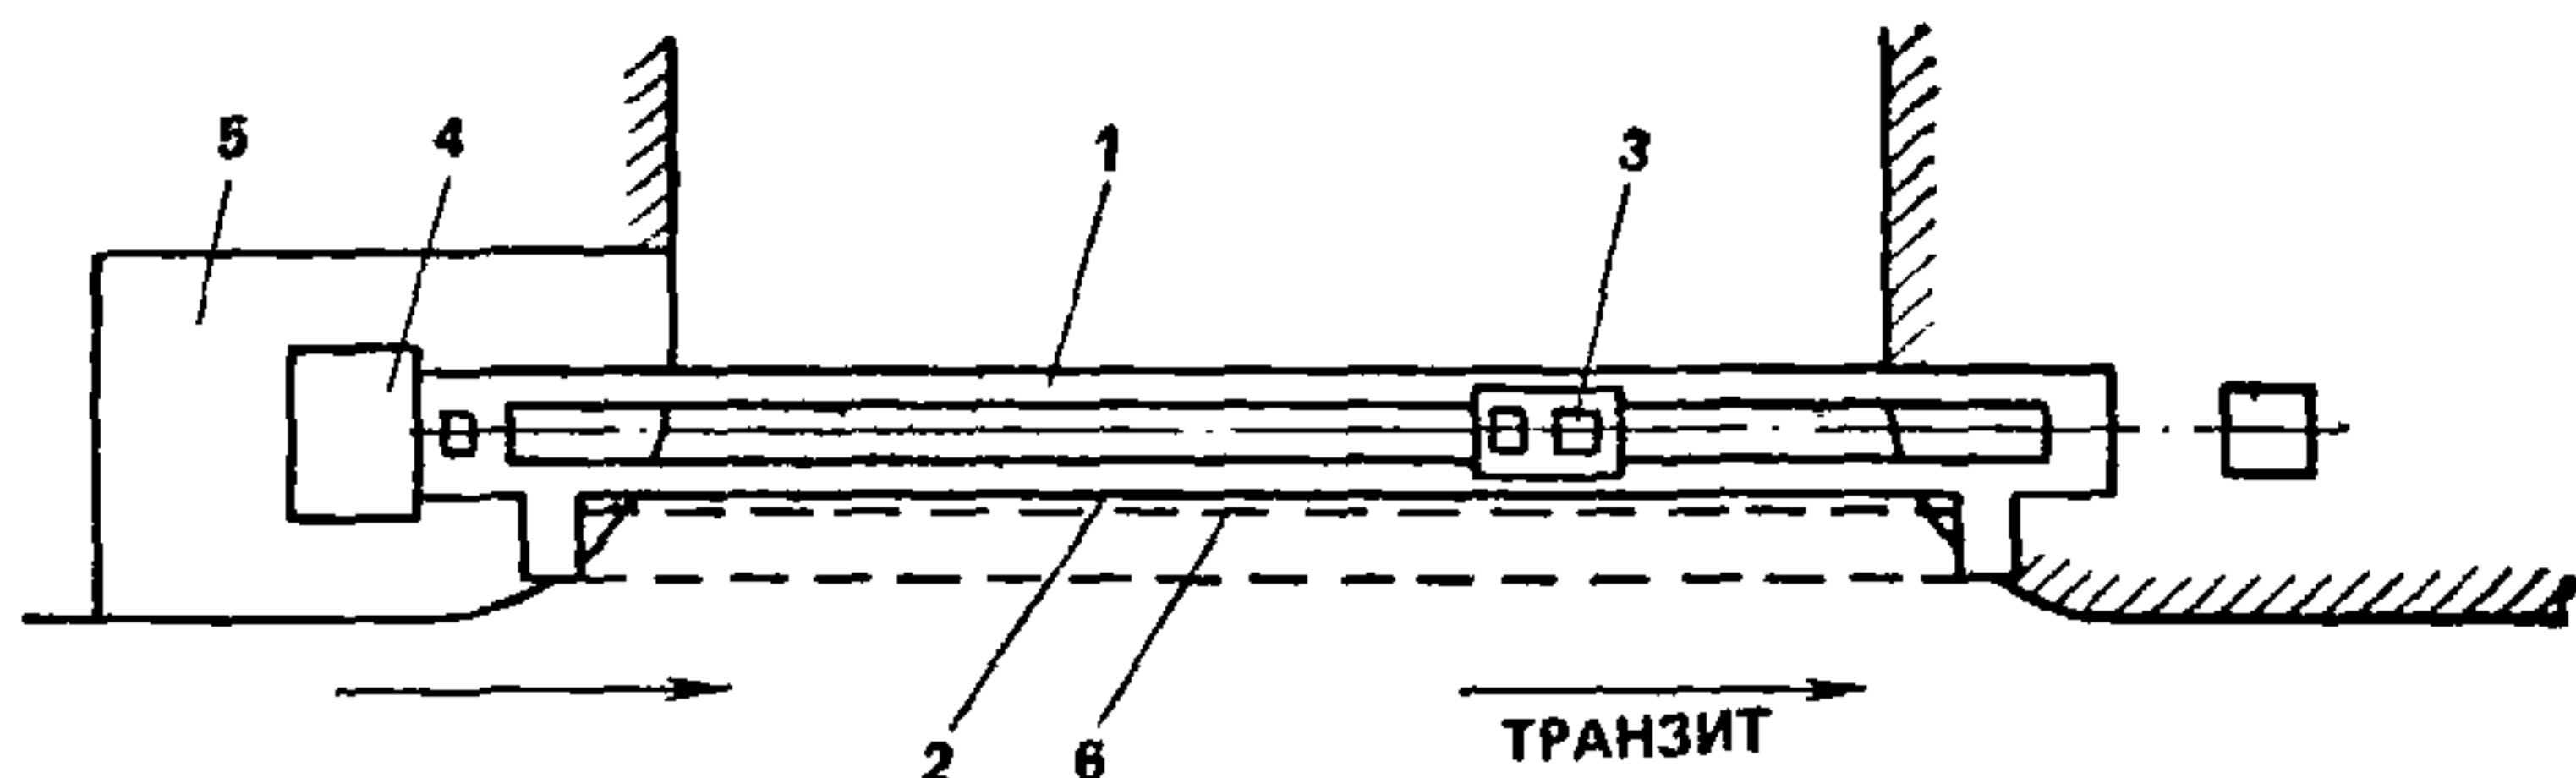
Схема расположения конструкции рыбозащитного устройства типа плоской сетки
